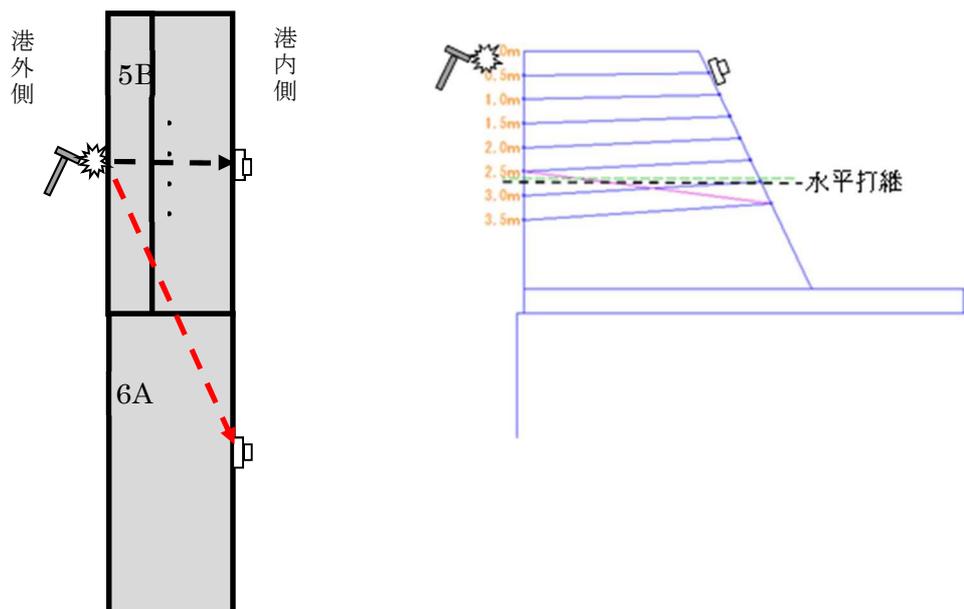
透過法測定イメージ (上部工) (左: 平面図、右: 断面図)
